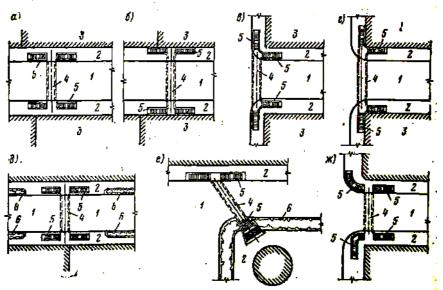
Схемы подземных пешеходных переходов типов 1-4: а — с входами у борта проезжей части на перегоне (тип 1); б — с входами у застройки или «красной линии» (тип 2); в — Γ - образный с входами у борта проезжей части на перекрестке (тип 3); г — Γ- образный с входами у застройки или «красной линии» (тип 4); д — с входами в пределах полосы насаждений; е — с раструбным лестничным сходом; ж — с дуговыми и Г-образными лестничными сходами: 1 - проезжая часть: 2 — тротуар; 3 — застройка; 4 — тоннель пешеходного перехода; 5 — лестничные сходы; 6 — зеленые насаждения.
